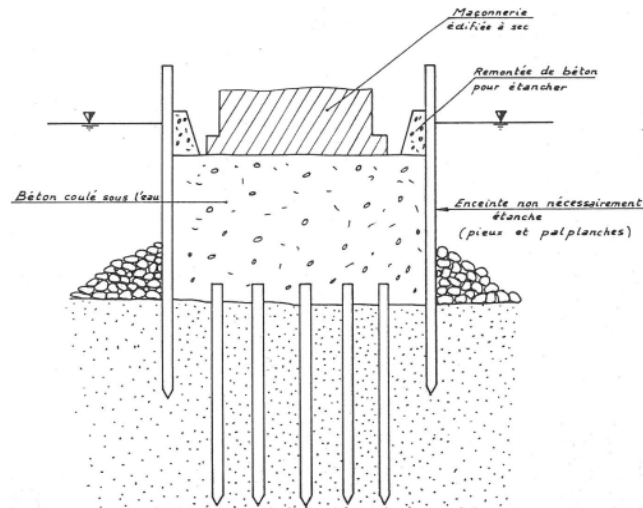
Fondation sur pieux et plate-forme en béton (Levillain, 1980)
